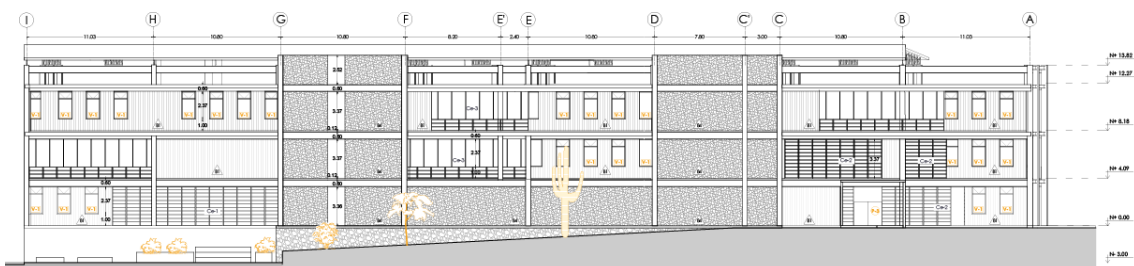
Fachada constructiva del centro comunitario de salud.
